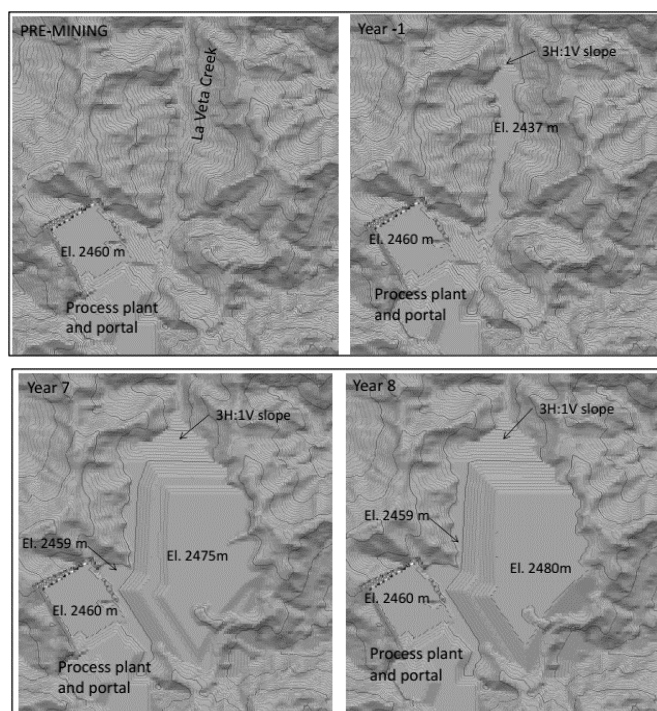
Proyecto minero Santa Rosa. Configuración proyectada del “Dry Waste Management Facility” (DWMF)
